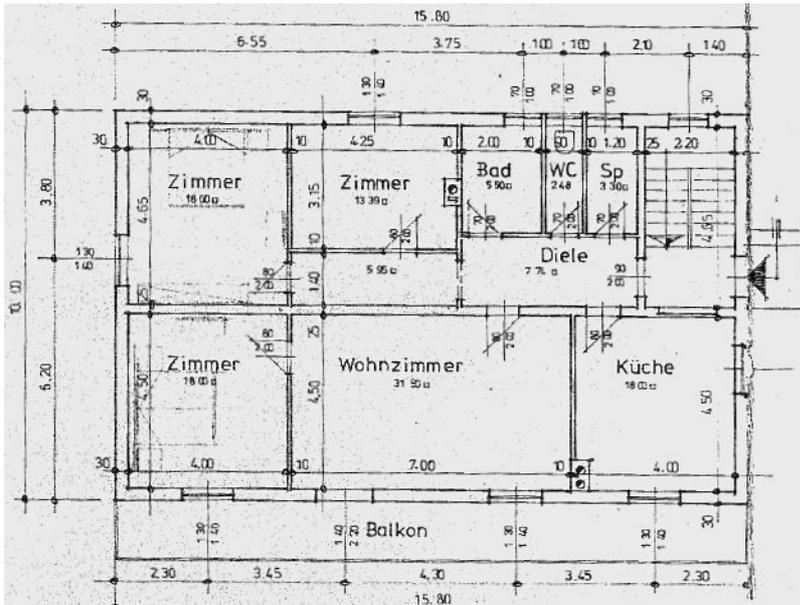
Grundriss 1. Obergeschoss Bestand [47]
